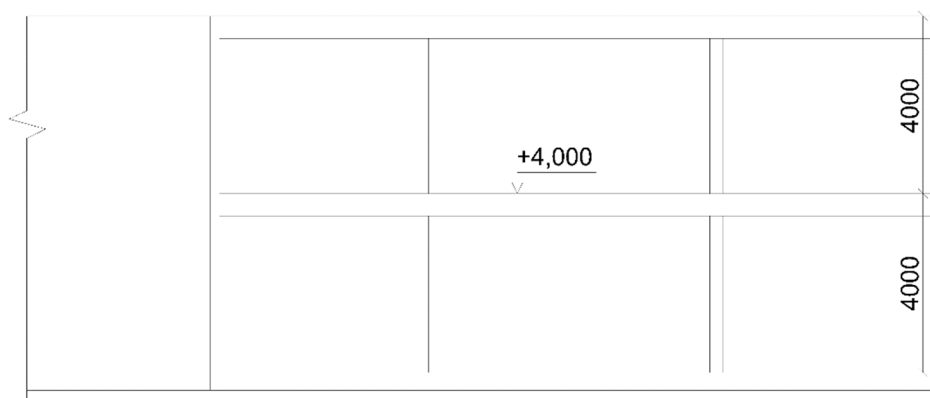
Schéma řešené konstrukce - půdorys
